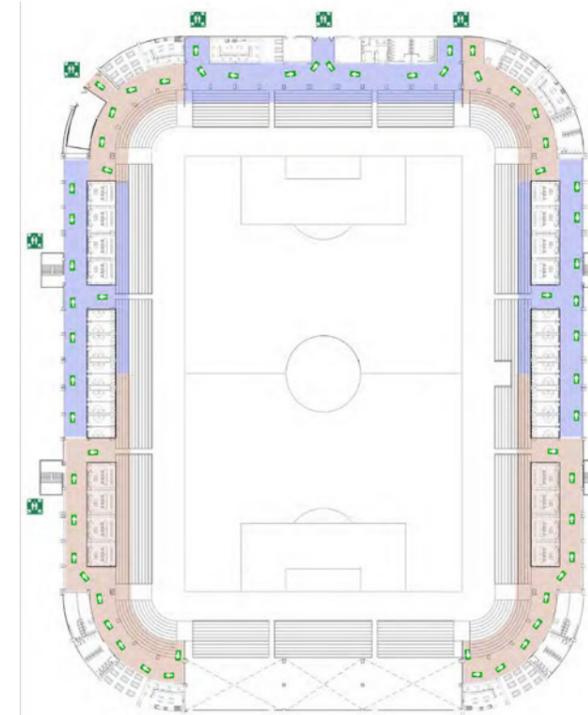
Planta de rutas de evacuación planta alta. Fuente: Elaboración propia.
